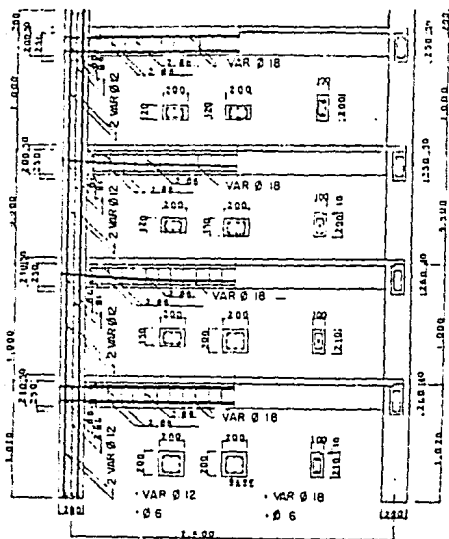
Detalle de dimensiones y refuerzo para un marco modelo de concreto prefabricado de 4 pisos.
